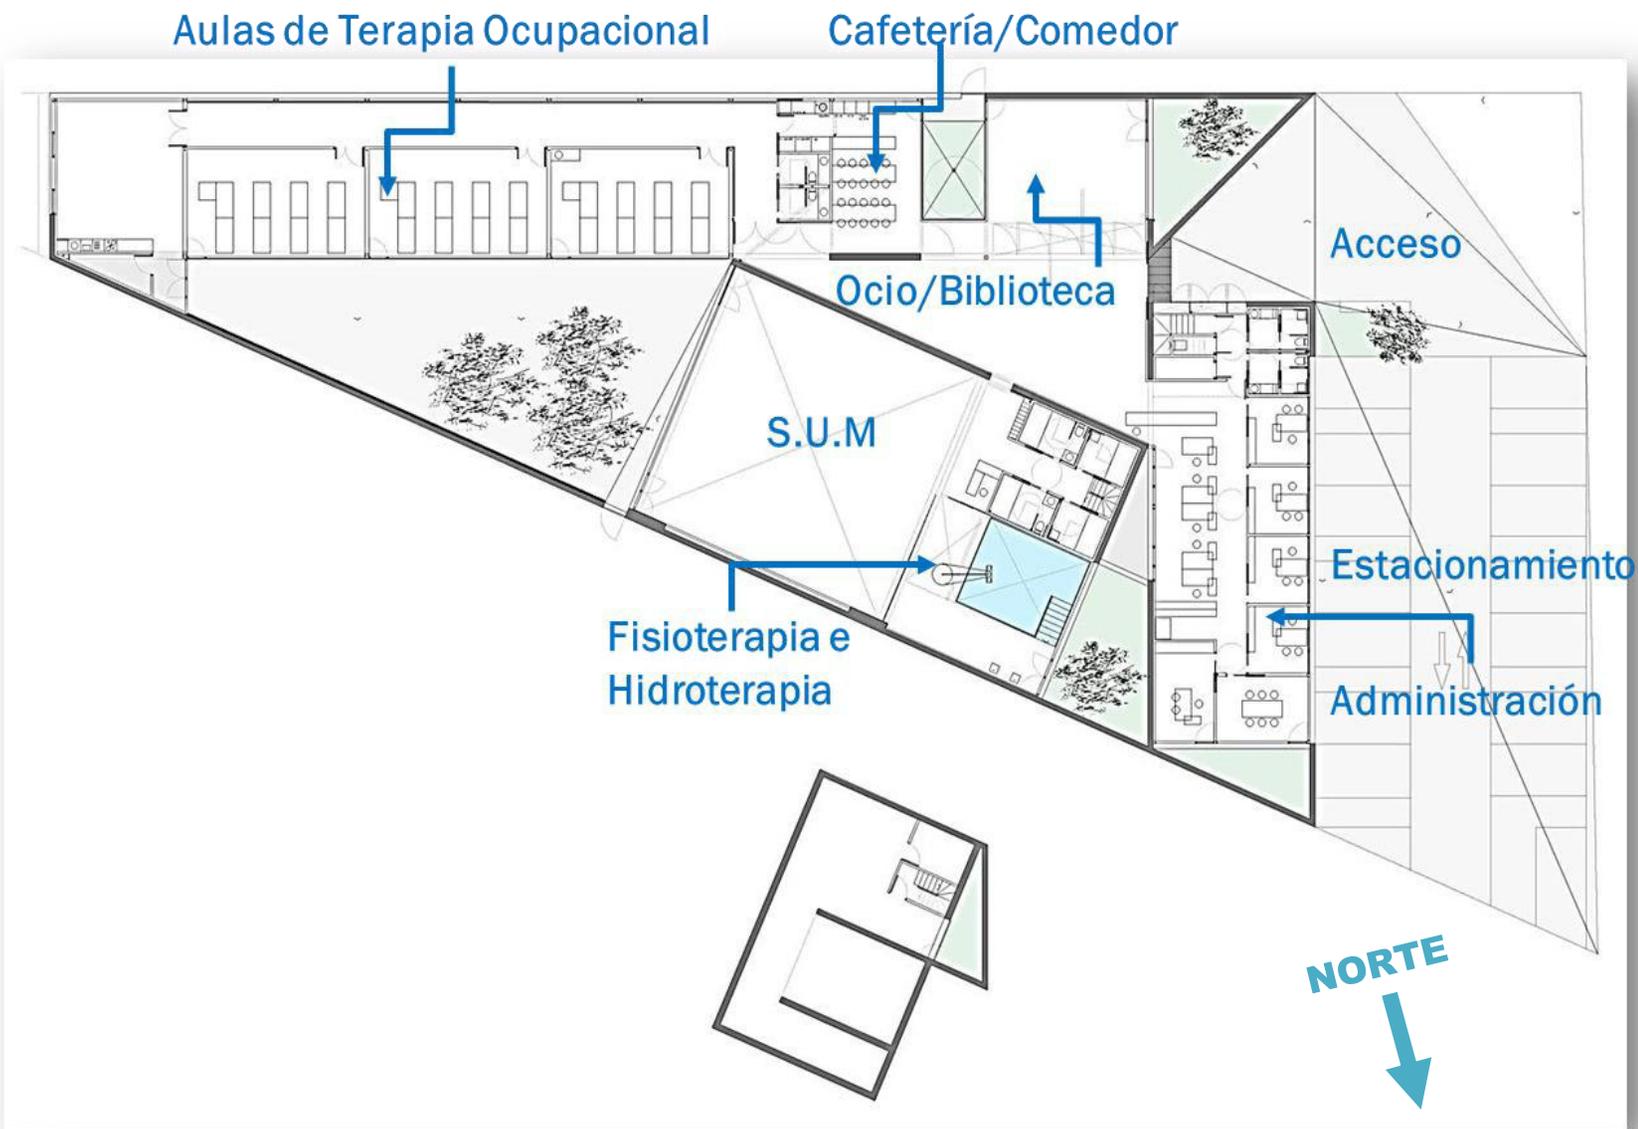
Planta de Distribución Espacial, Centro ASPAYM.
